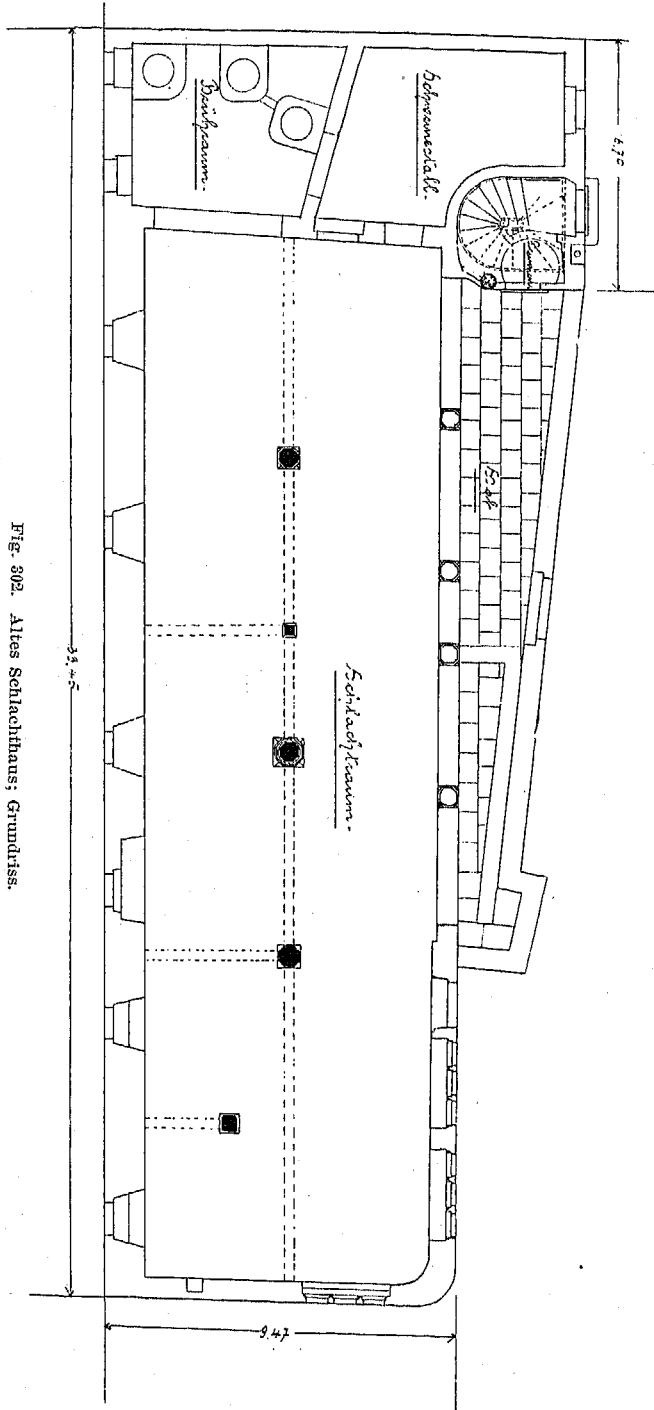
Altes Schlaehhaus; Grundriss.
